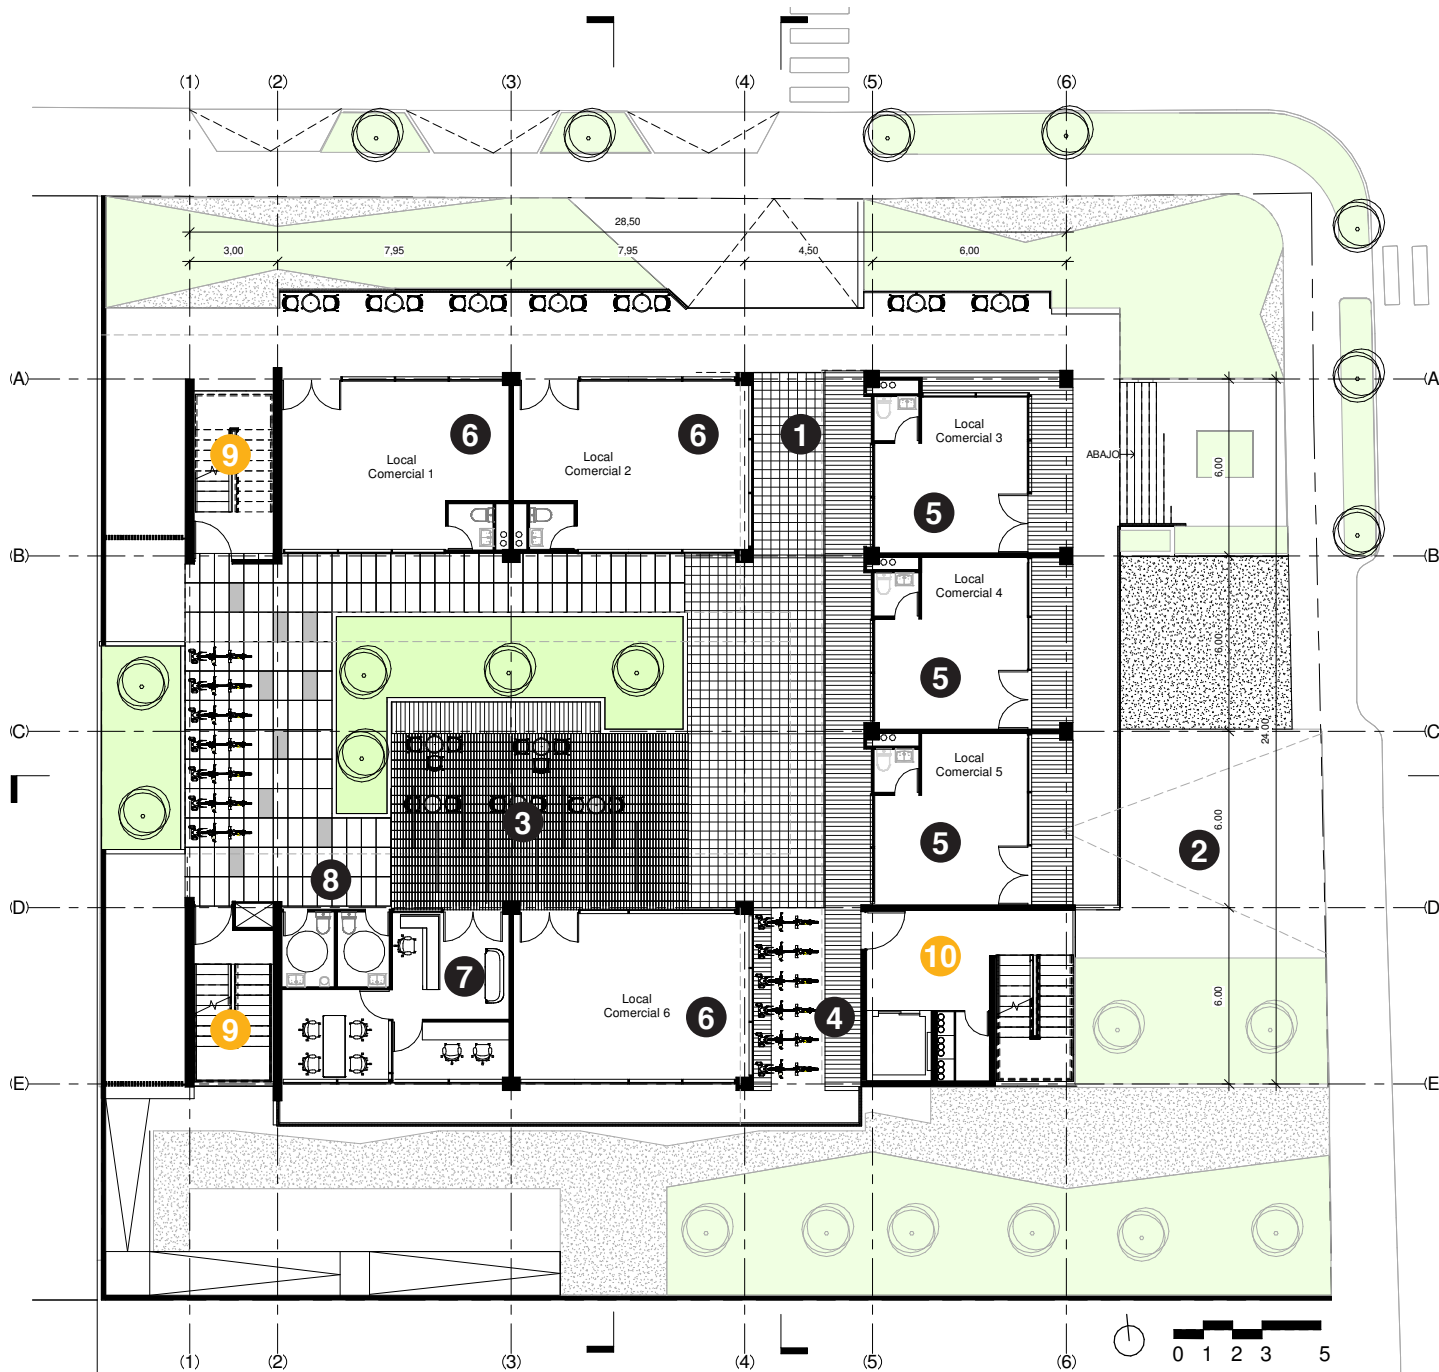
Planta de distribución nivel 0. bloque espacio público/ área comercial. Fuente propia.
